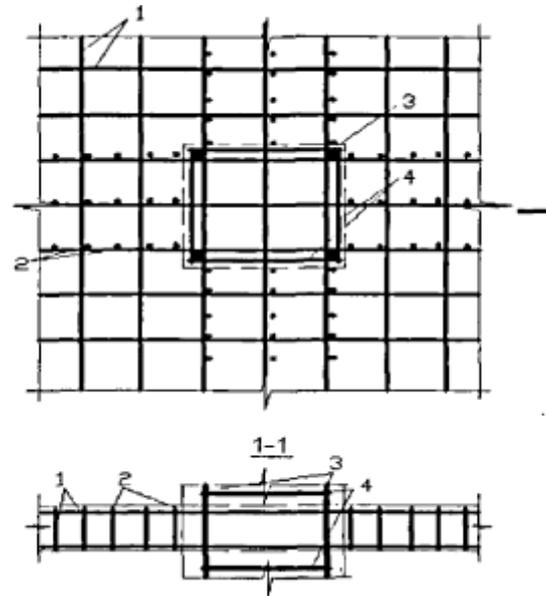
Узел сопряжения безбалочной плиты монолитного перекрытия с колонной без капители [2]
